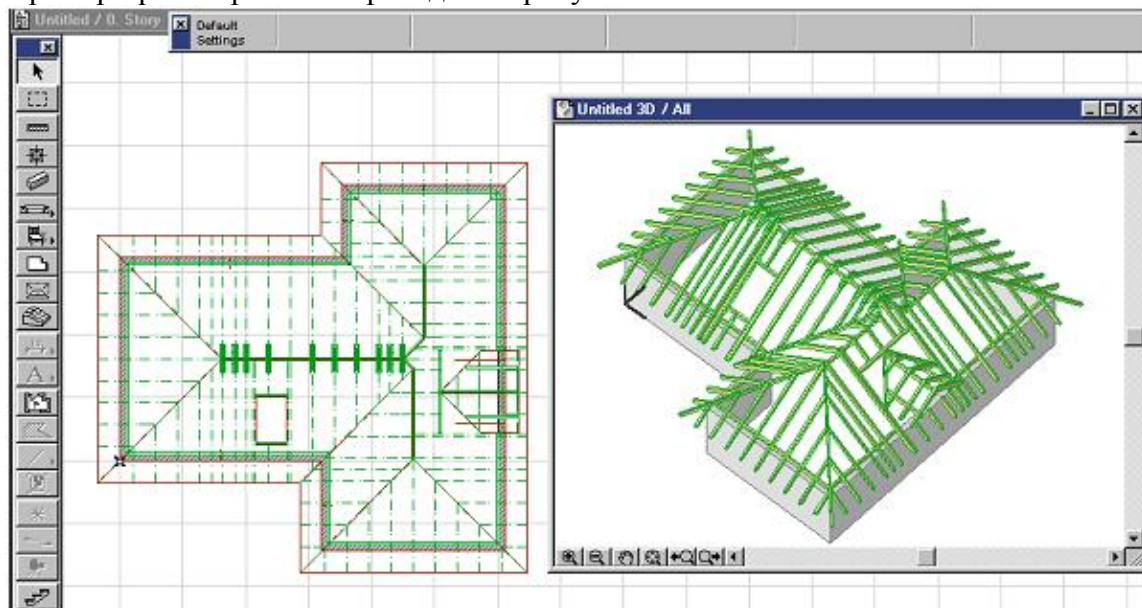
Вид стропильных конструкций на плане этажа и в 3D.
